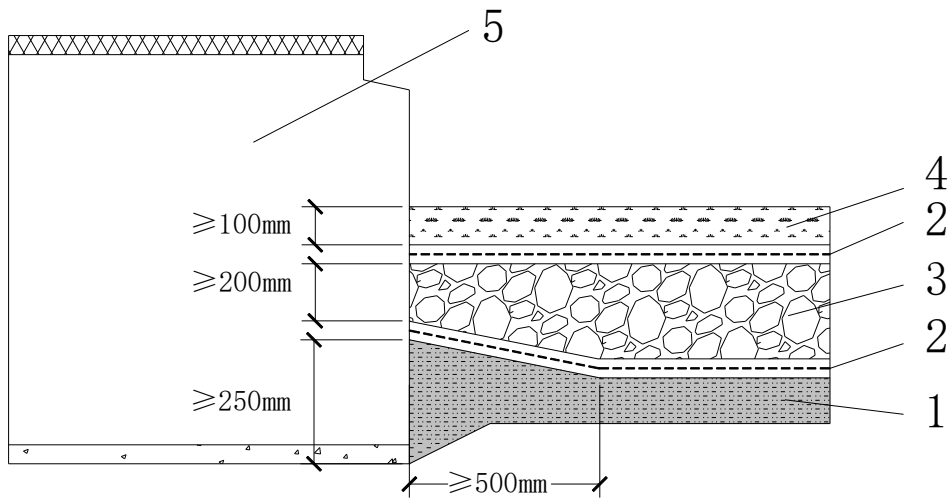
5. 2-6 混凝土罐基础衔接设计示意图
